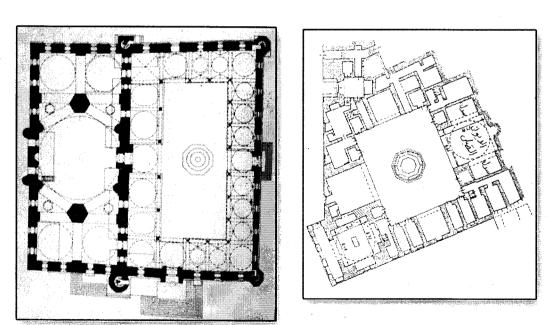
مسجد الصالح طلائع (مسقط أفقي) عن : جورج ميشيل
